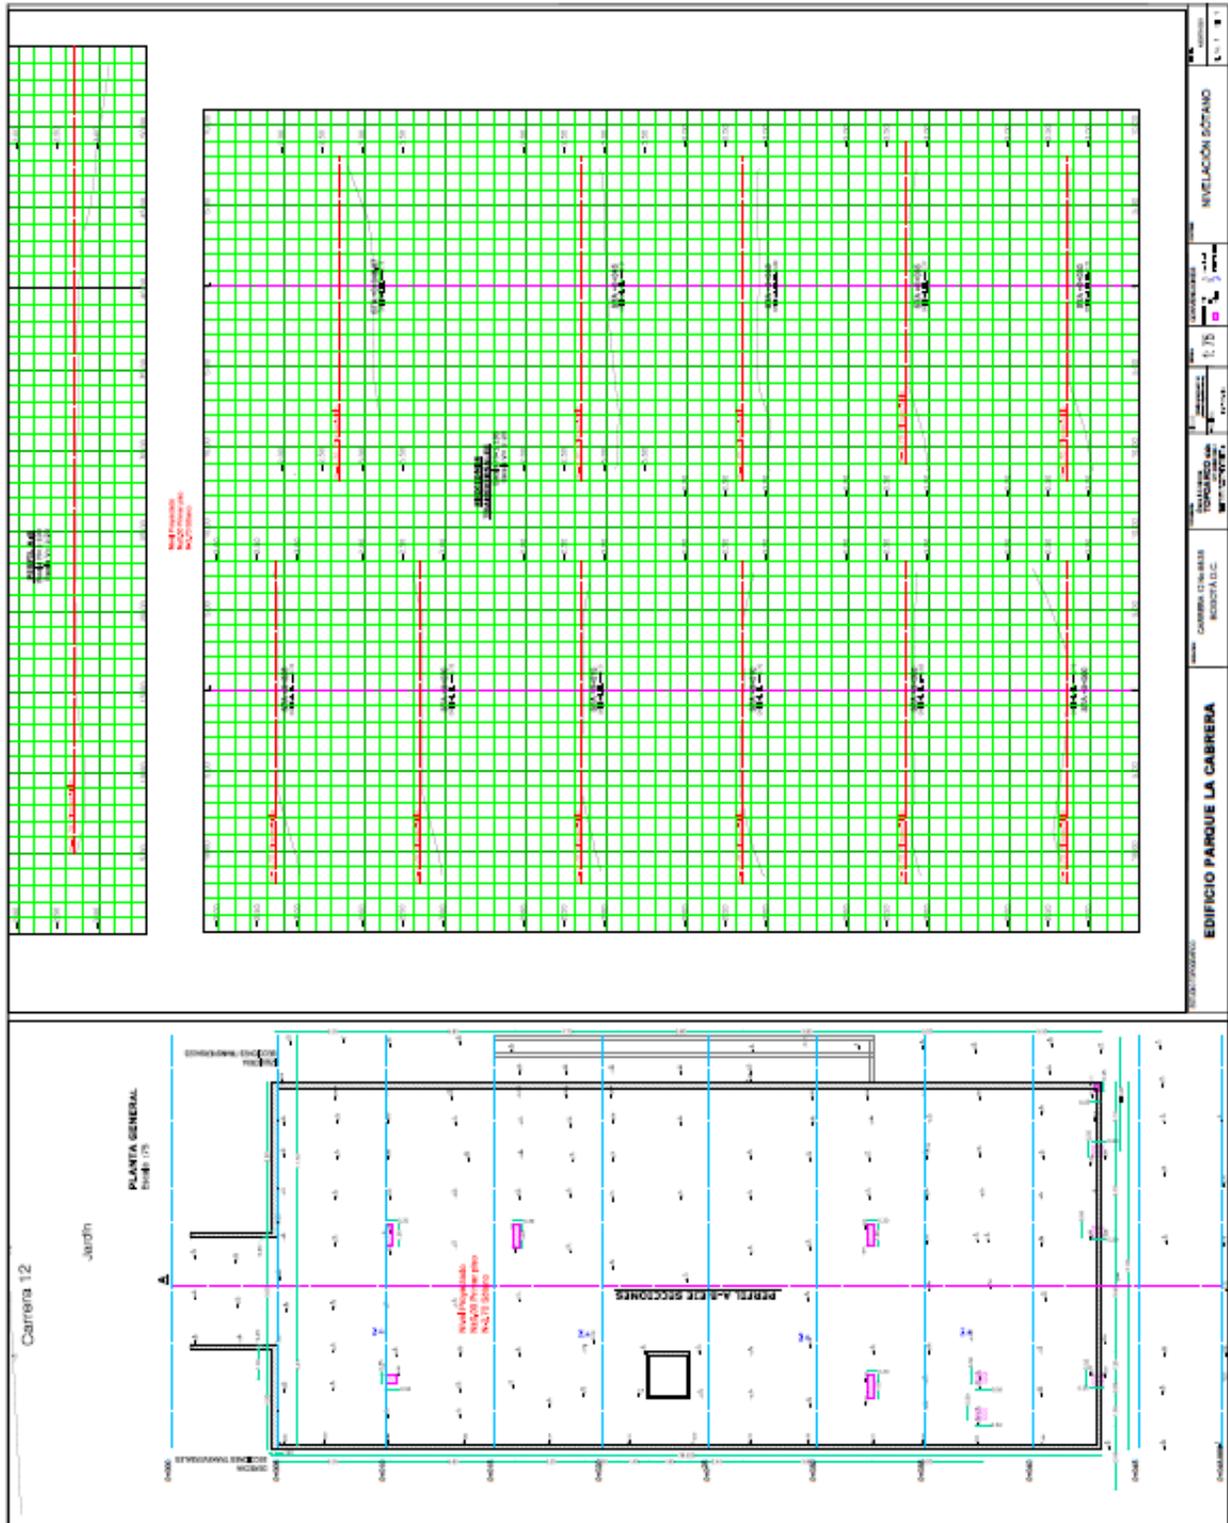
Planta perfil sótano del Ed. La Cabrera PH.
